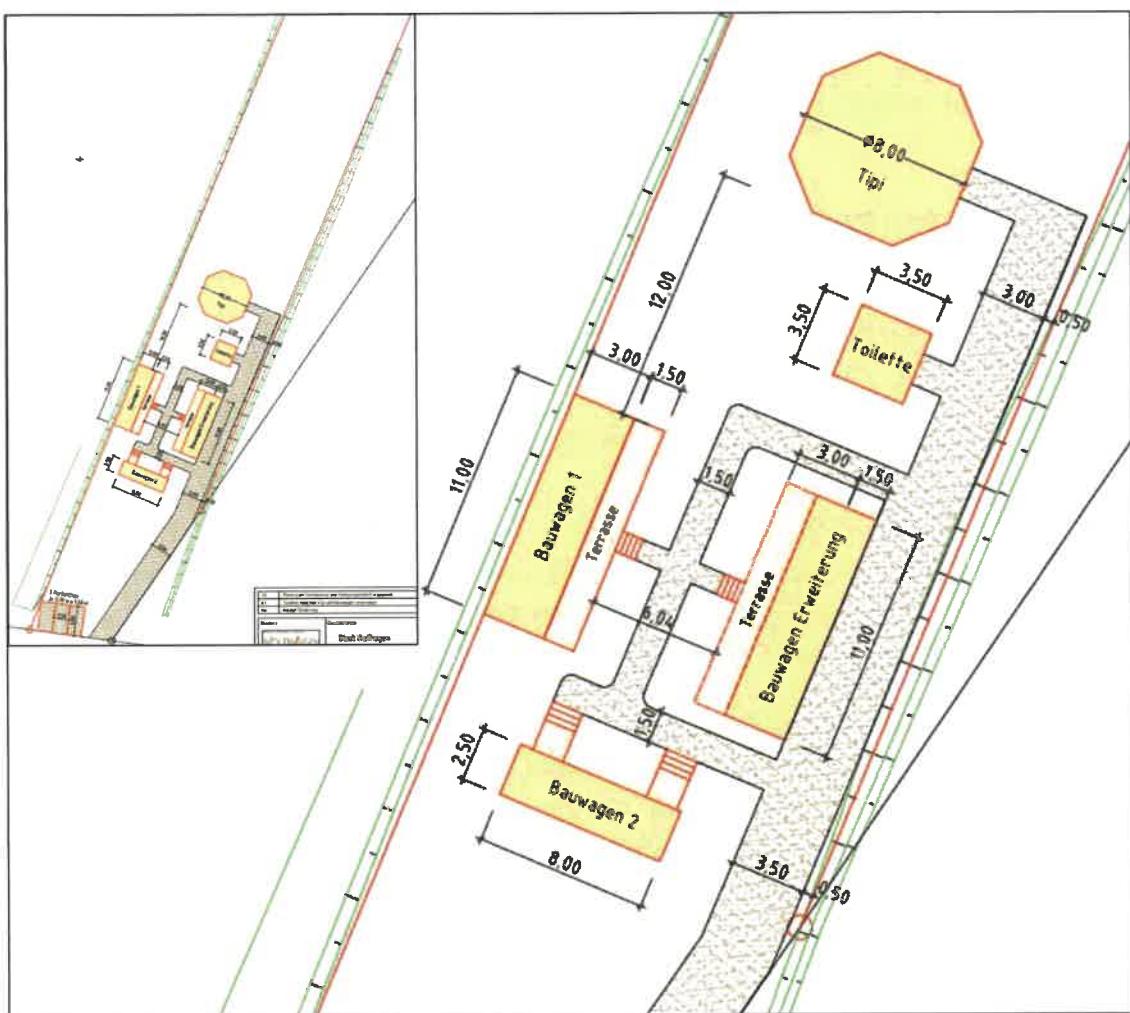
Lageplan des Waldkindgartens (LZU 2025)
